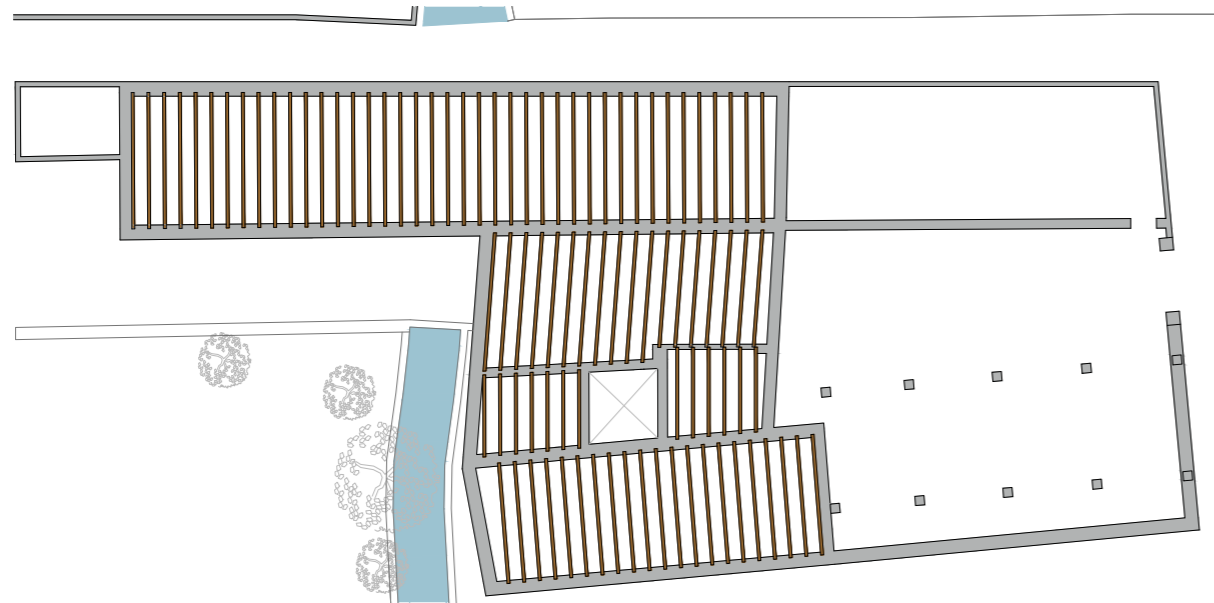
Esquema del forjado de primera planta del edificio. Autor Propio 2015
